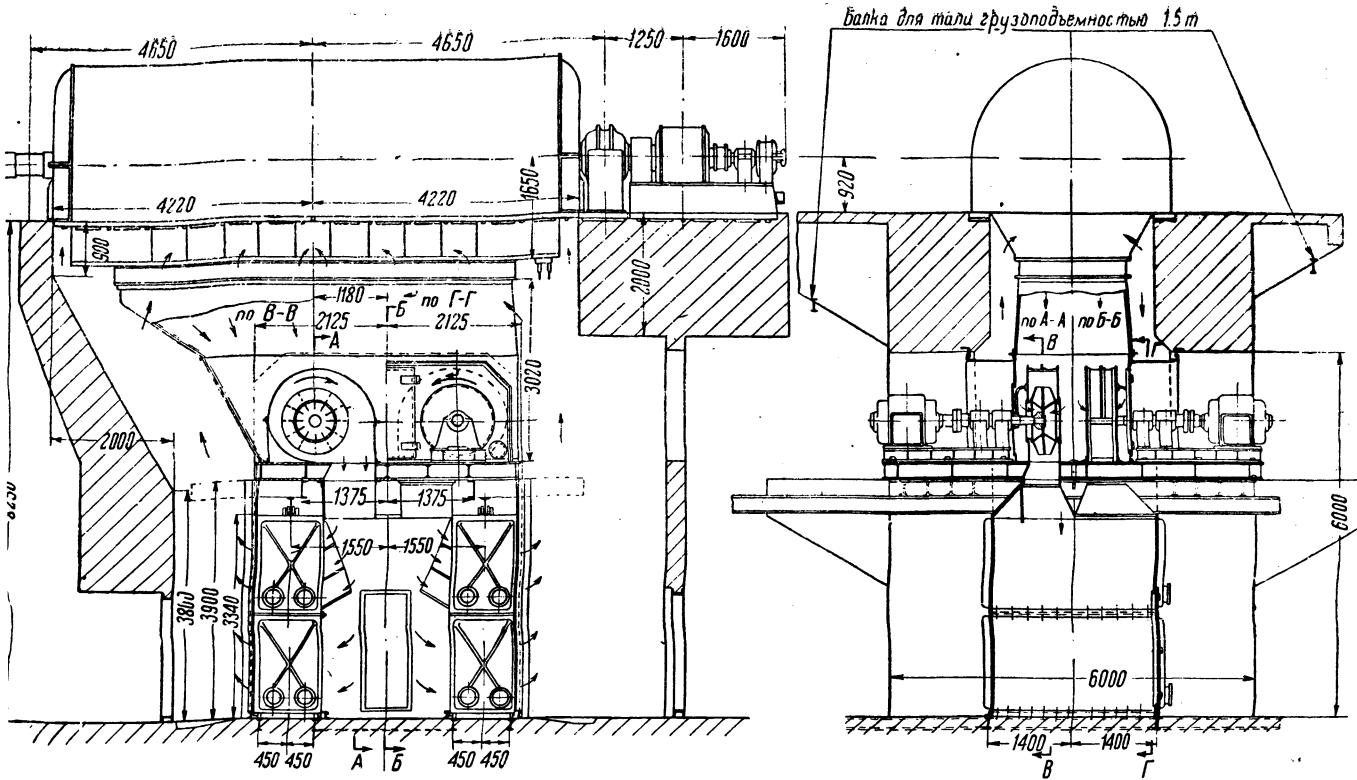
Вентиляционное и воздухоохладительное устройства (продольный и поперечный разрезы)
